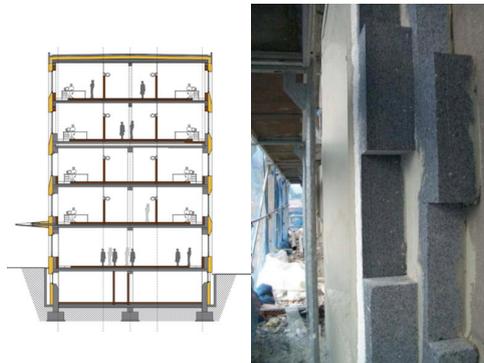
Sezione e foto che illustrano l'isolamento aggiunto alle pareti originali dal progetto di retrofit.
